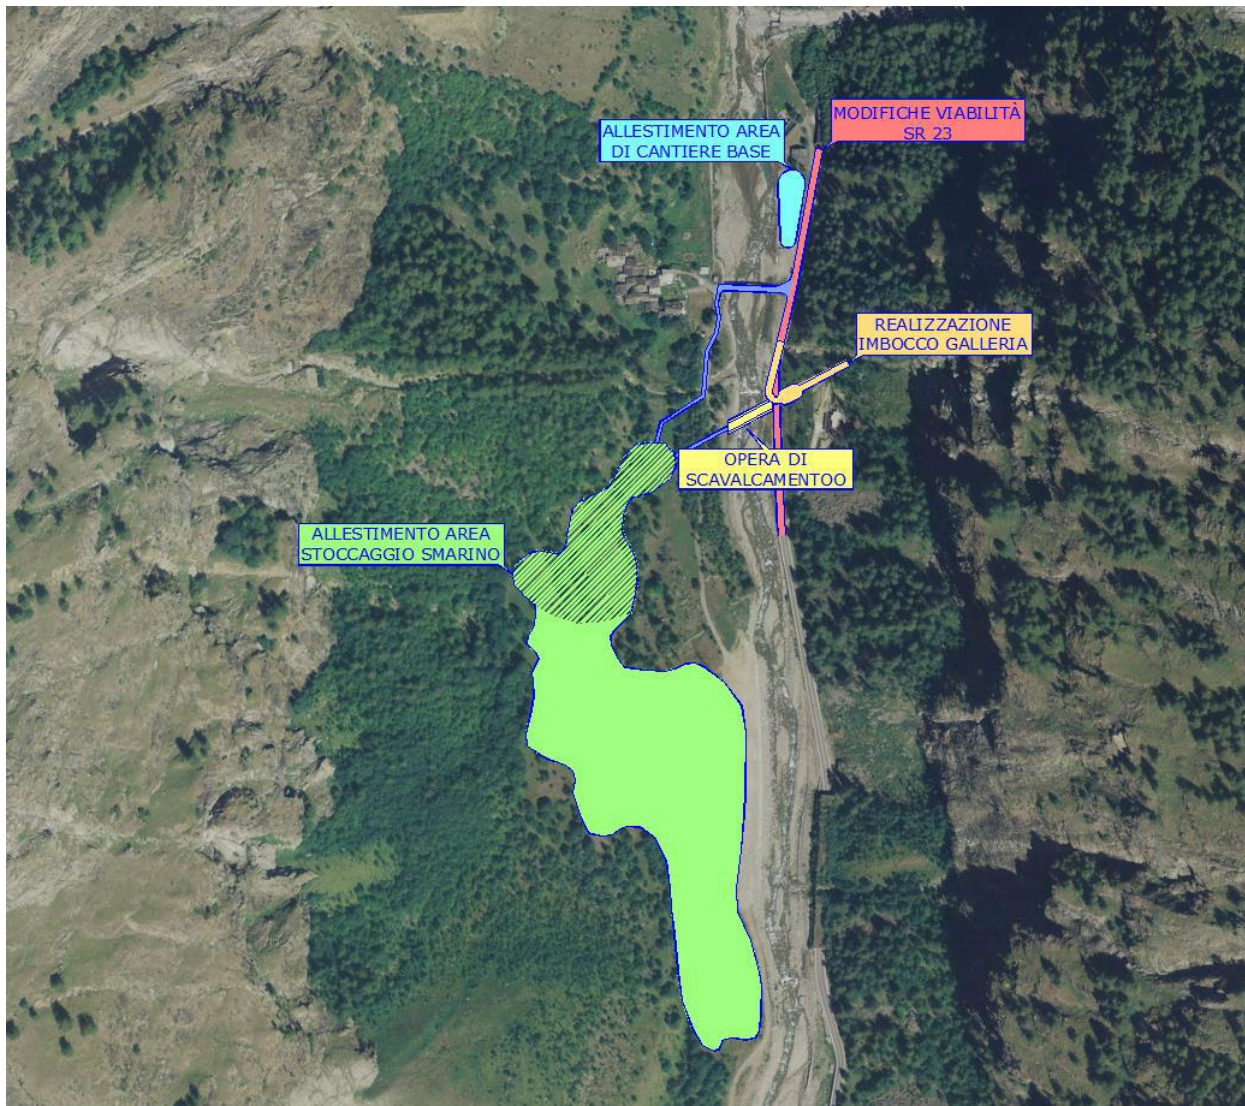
Lotto I cantiere A realizzazione gallerie
